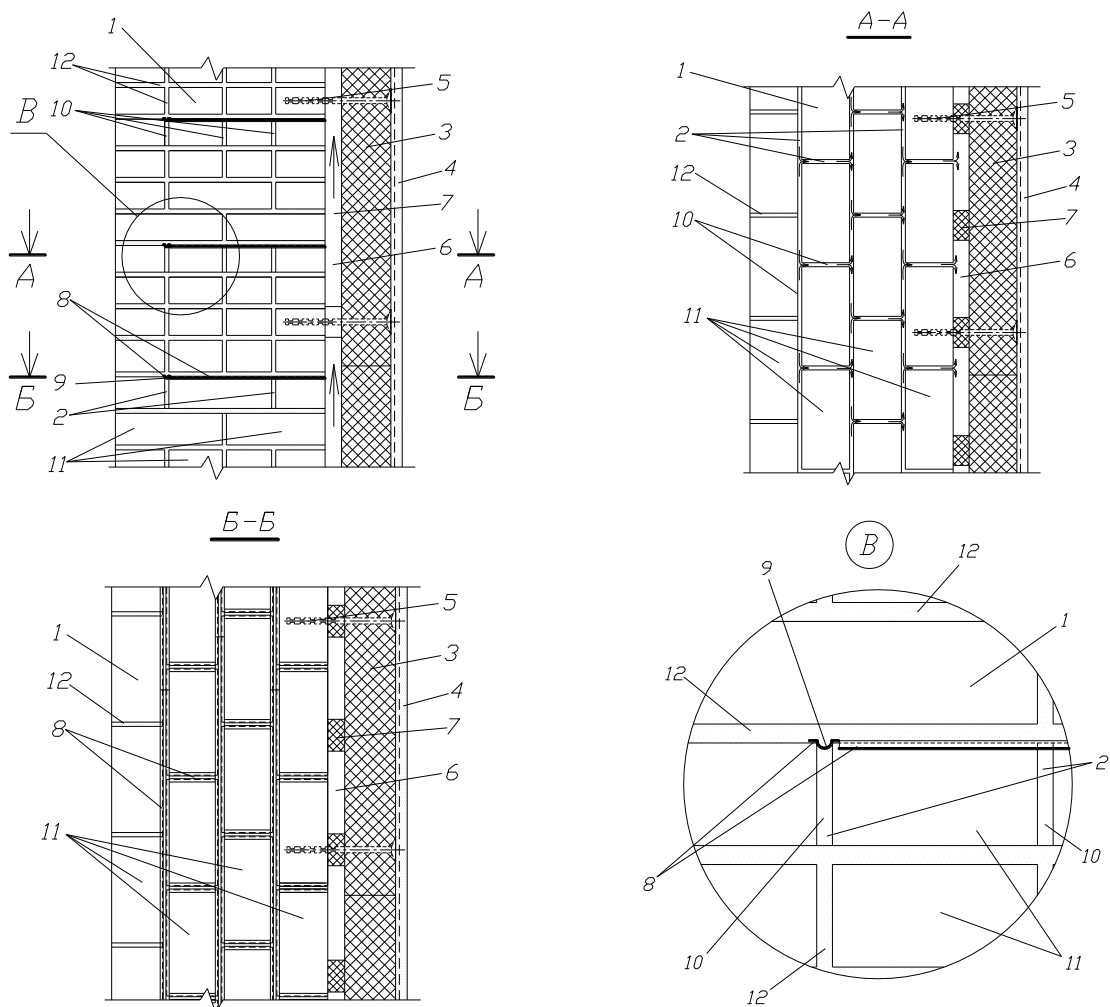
Утепленная наружная стена со вскрытой системой воздушных каналов в теле кладки по А.с. СССР №1448006 [2]
